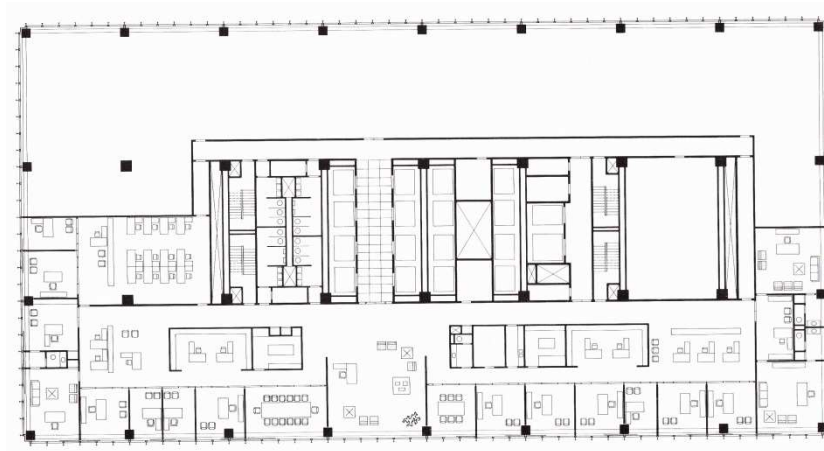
Planta Baixa | Pavimento Tipo Office Tower. (FONTE: CARTER, 1999).
